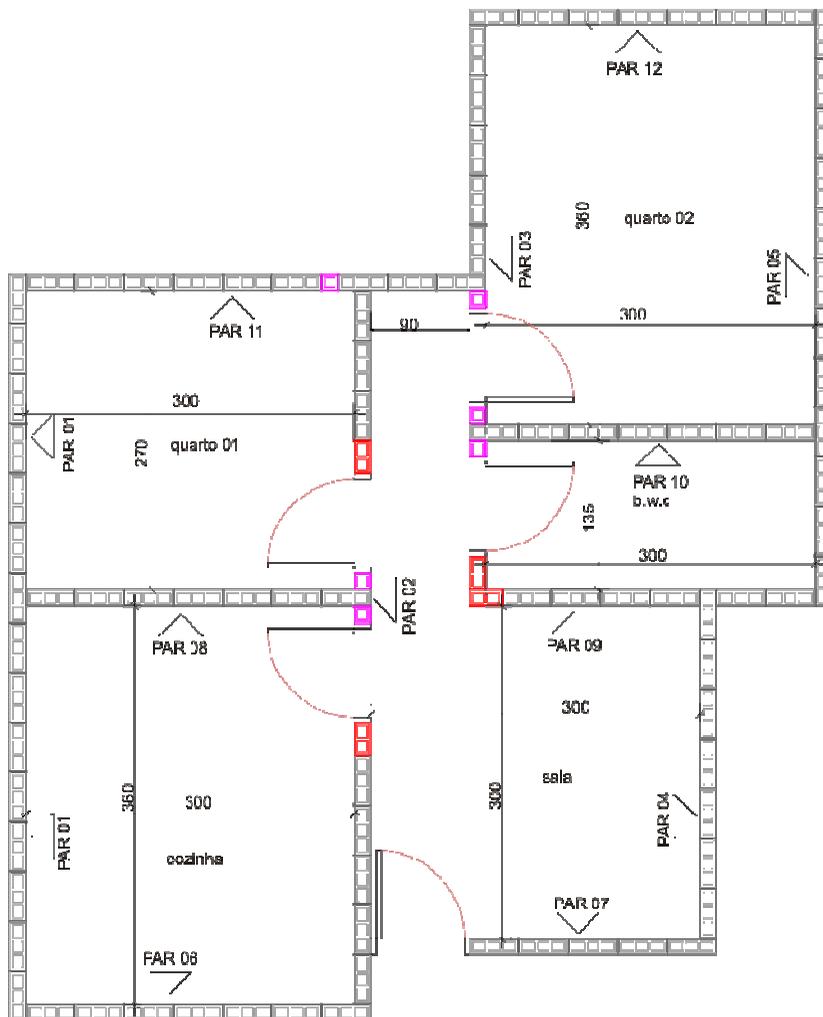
Planta Baixa de modulação da segunda fiada para a Modulação 04
